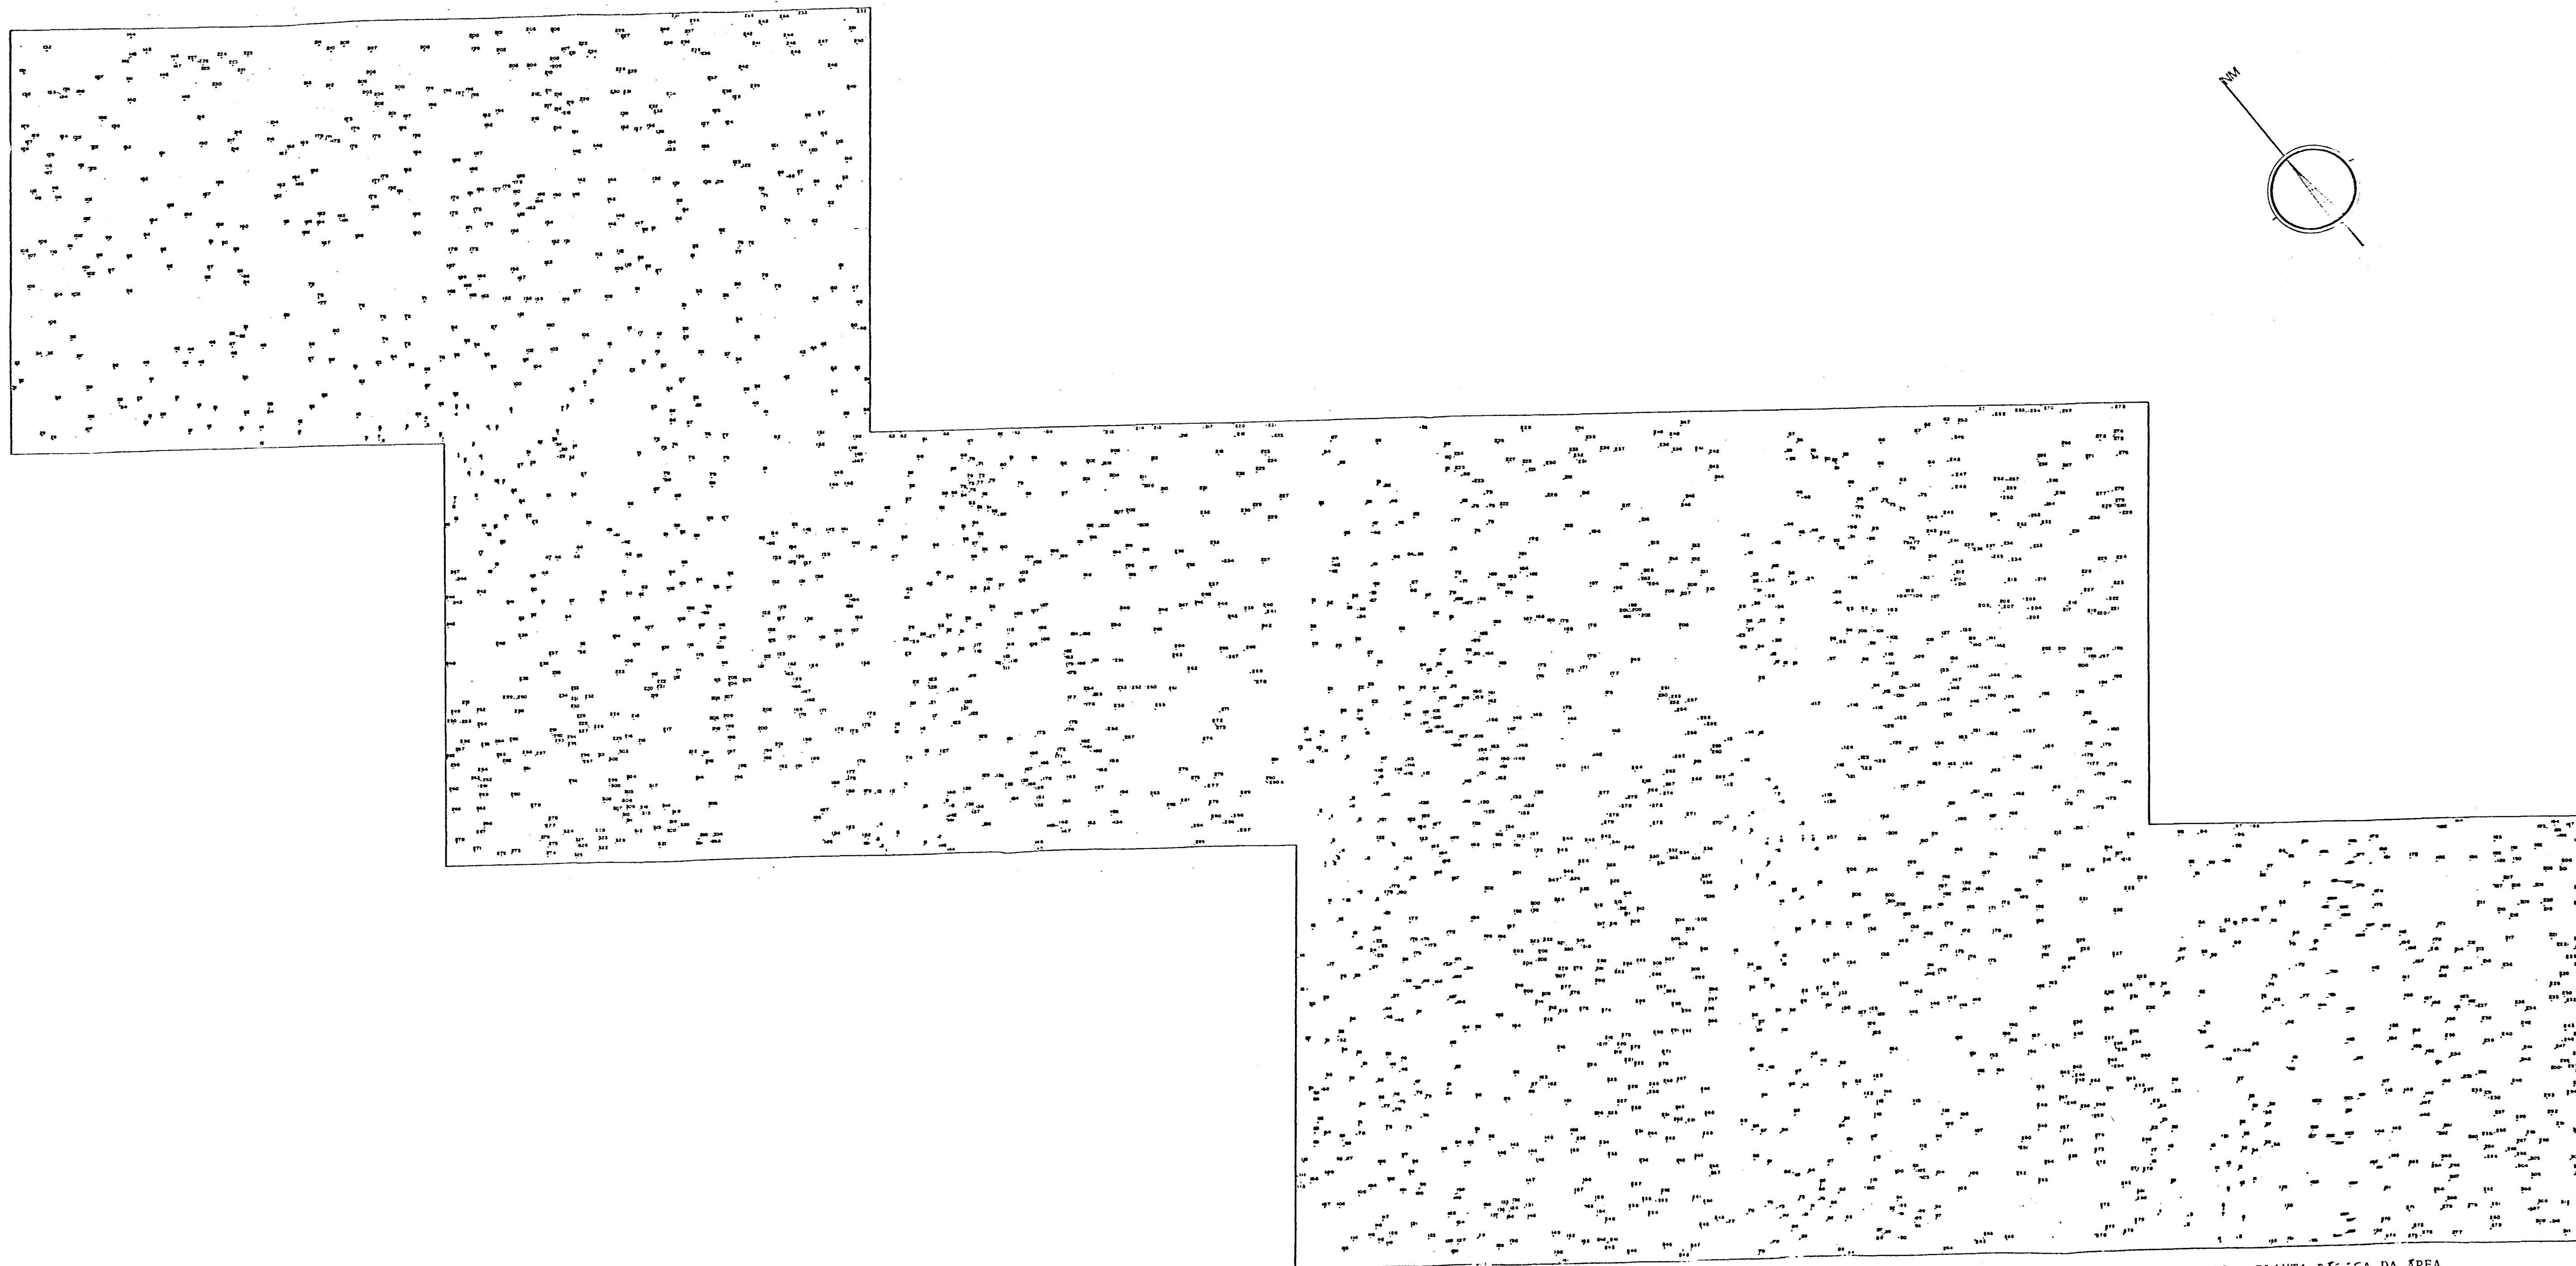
PLANTA BÁSICA DA ÁREA
